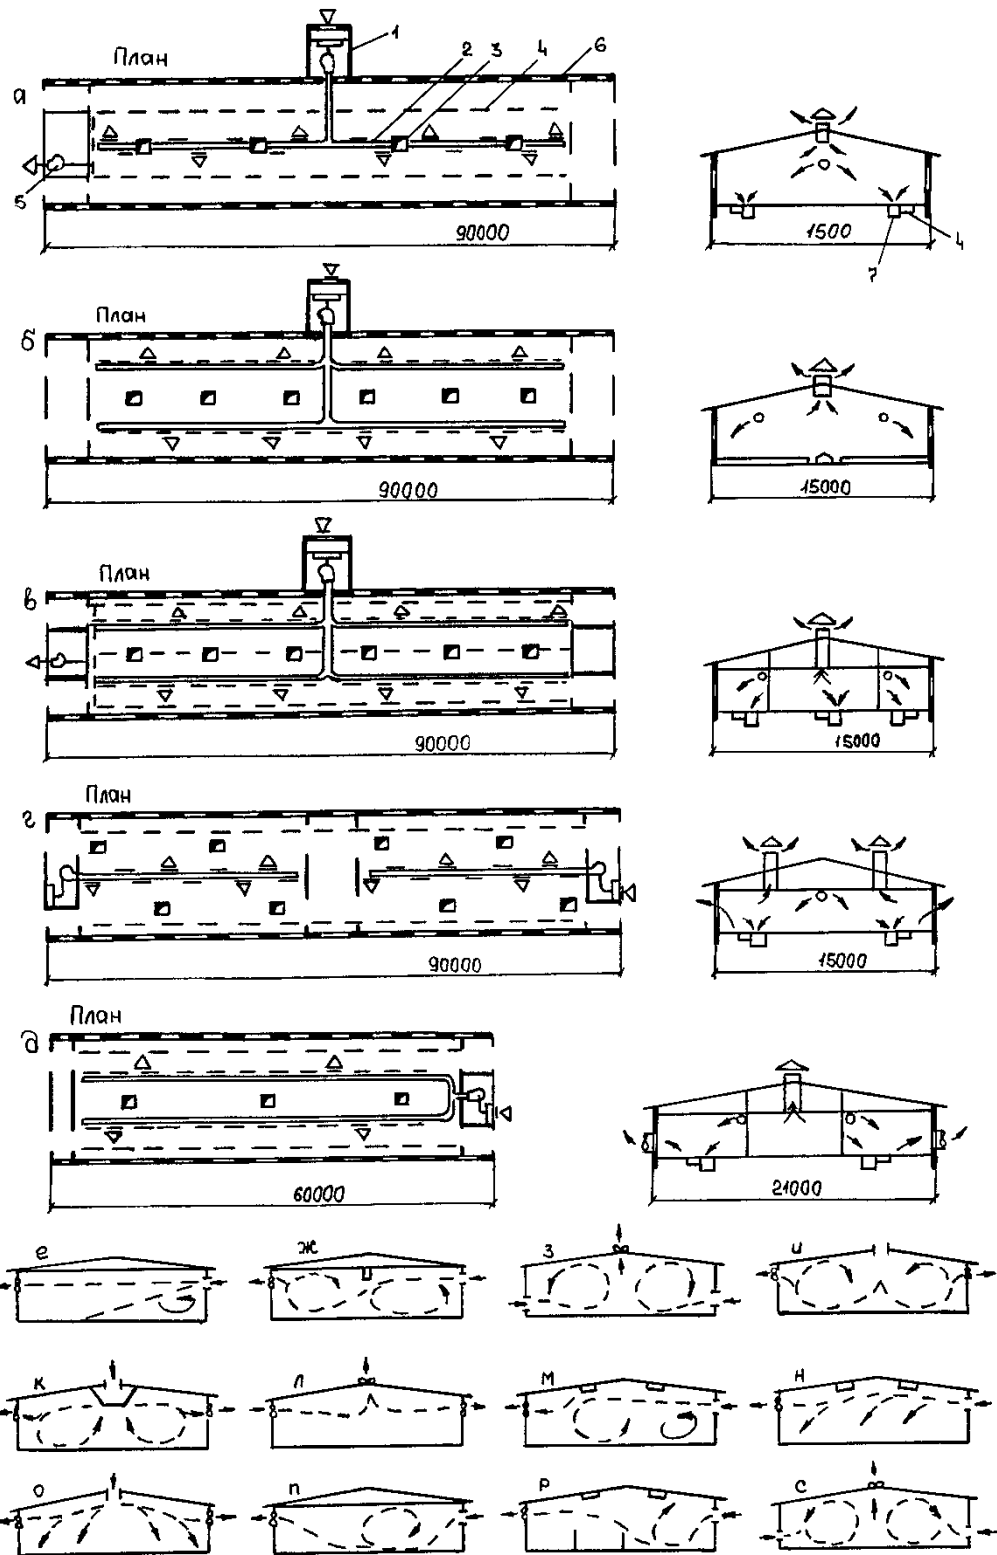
Схемы вентиляции животноводческих помещений. 1 – приточный центр; 2 – приточный воздуховод; 3 – вытяжная шахта; 4 – подпольный воздуховод; 5 – вытяжной вентилятор; 6 – окно; 7 – навозный канал; 8 – осевой вентилятор; 9 – вентиляционное отверстие.
